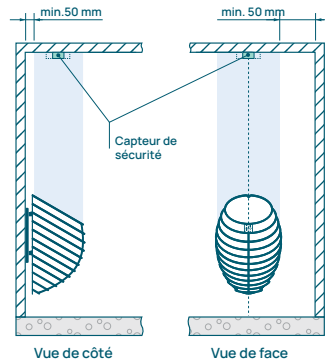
Installation du capteur de sécurité au plafond : chauffage mural
